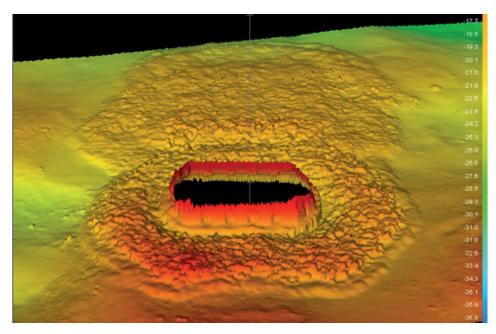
Colocación de rocas alrededor de un pilar y entre dos pilares en el puente Little Belt
